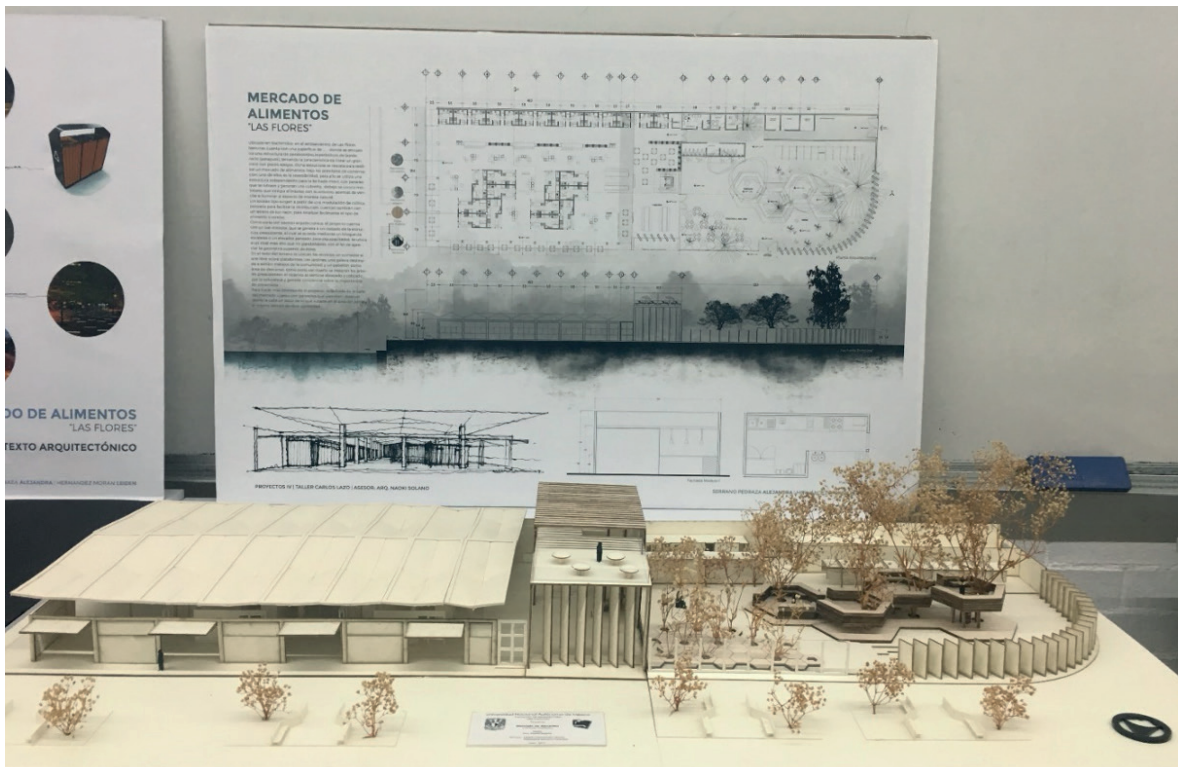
Proyecto de Alejandra Serrano y Leiden Morán, 4to semestre.
